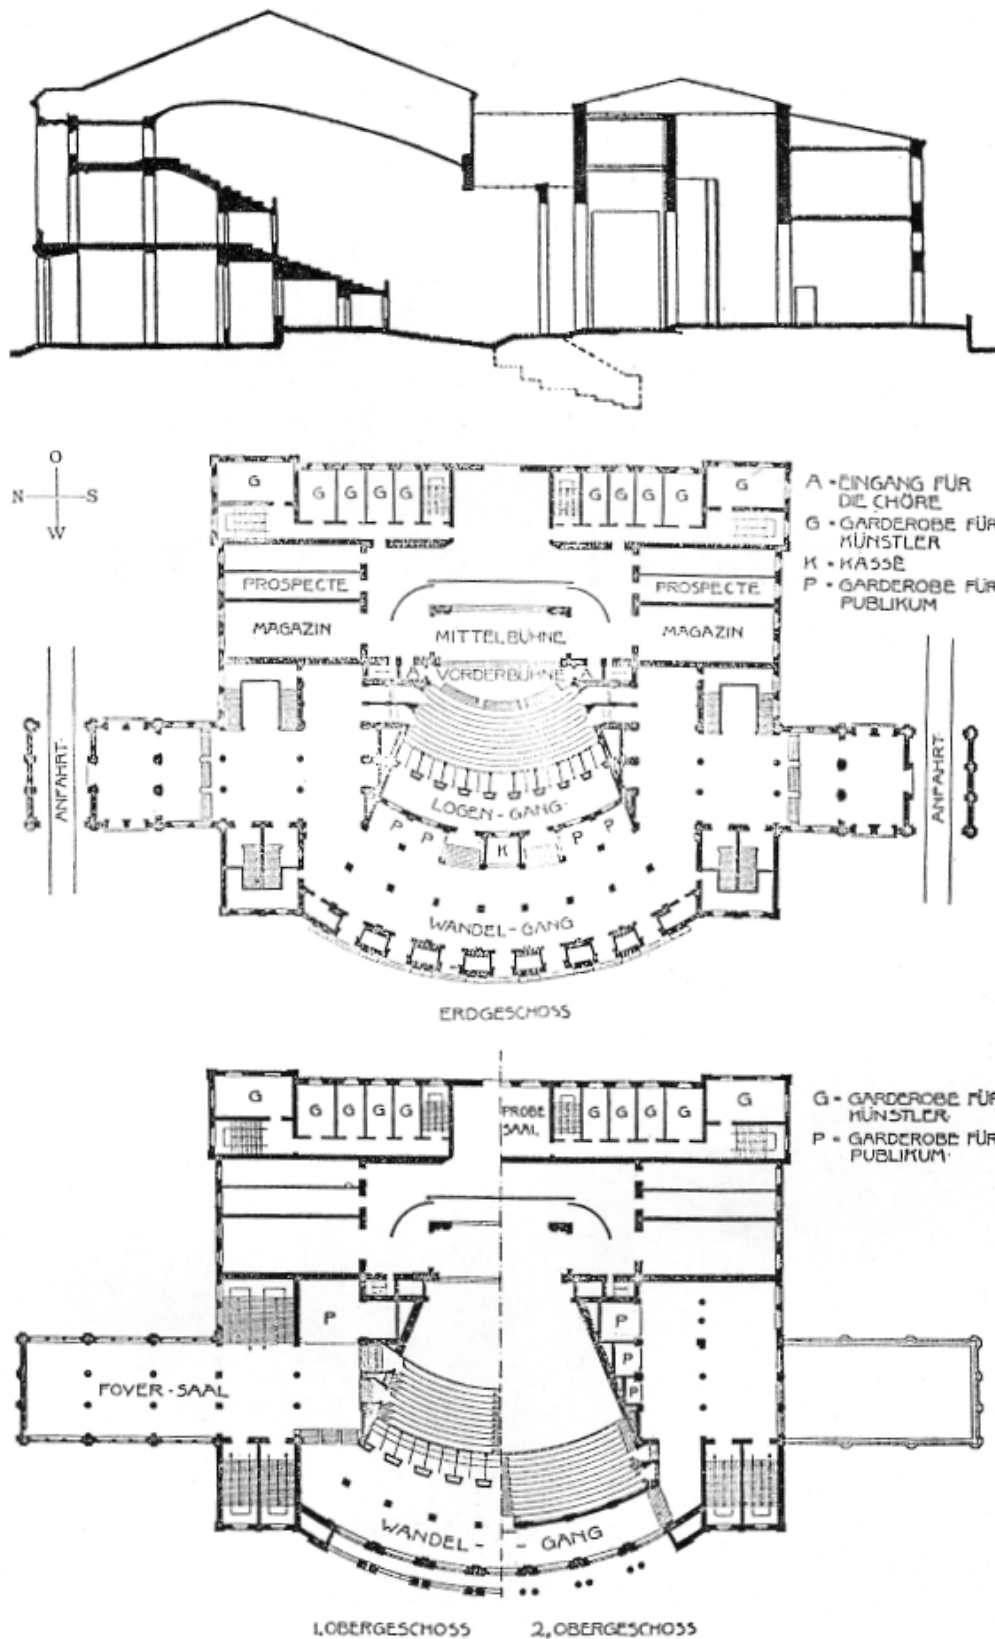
Progetto di teatro di M. Littmann, sezione longitudinale, pianta primo livello e pianta secondo livello.
